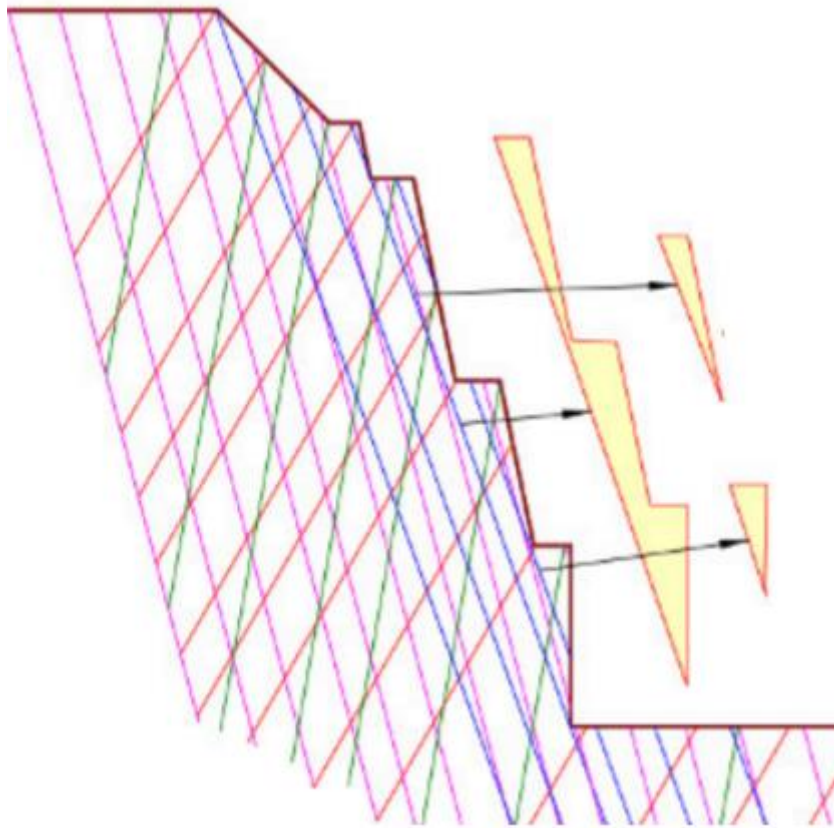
Corte principal y planos de juntas con la sección transversal del pozo de excavación
